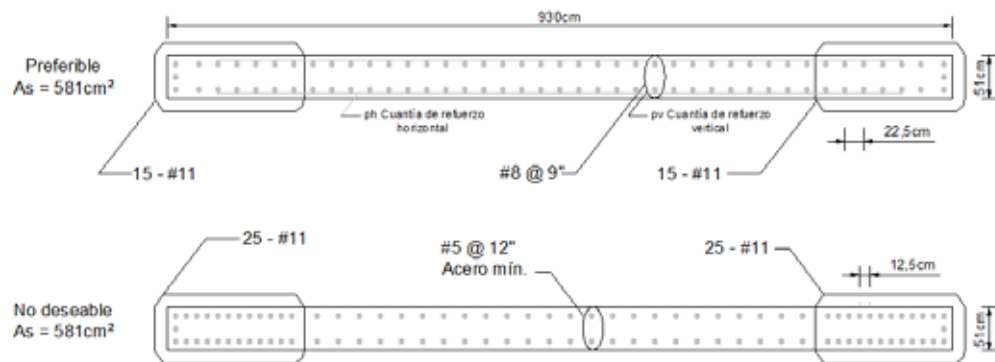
Distribución del acero de refuerzo longitudinal en la sección transversal de un muro.
